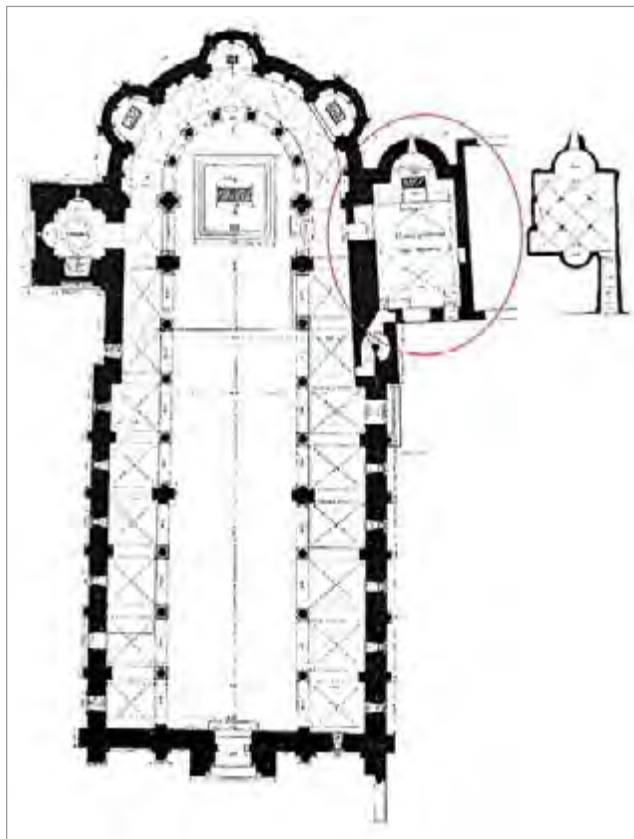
Planimetria della chiesa abbaziale. Con il cerchio è indicata l'attuale Sagrestia con a lato la pianta della sottostante cripta (rielaborazione da CANESTRELLI 1912, tav. 11).
